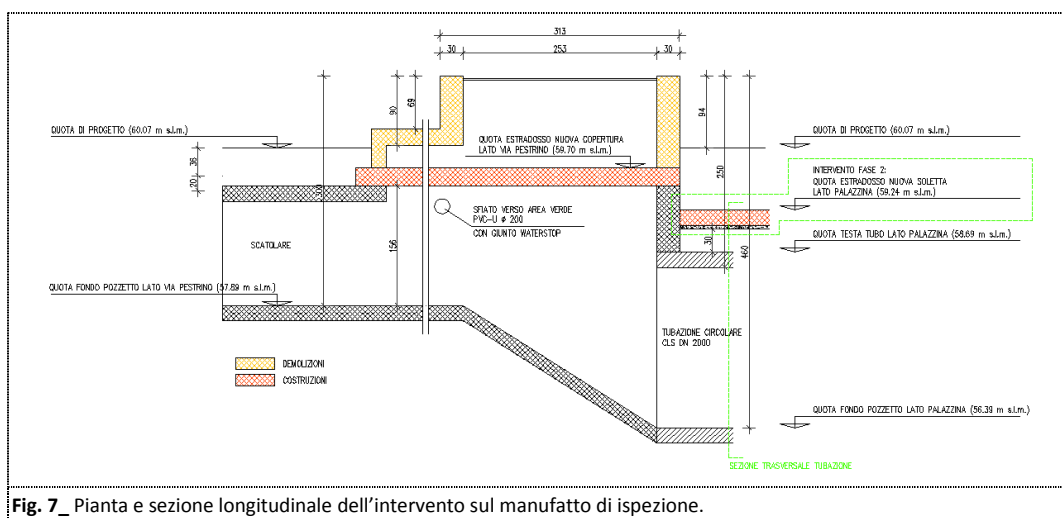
Pianta e sezione longitudinale dell'intervento sul manufatto di ispezione.
